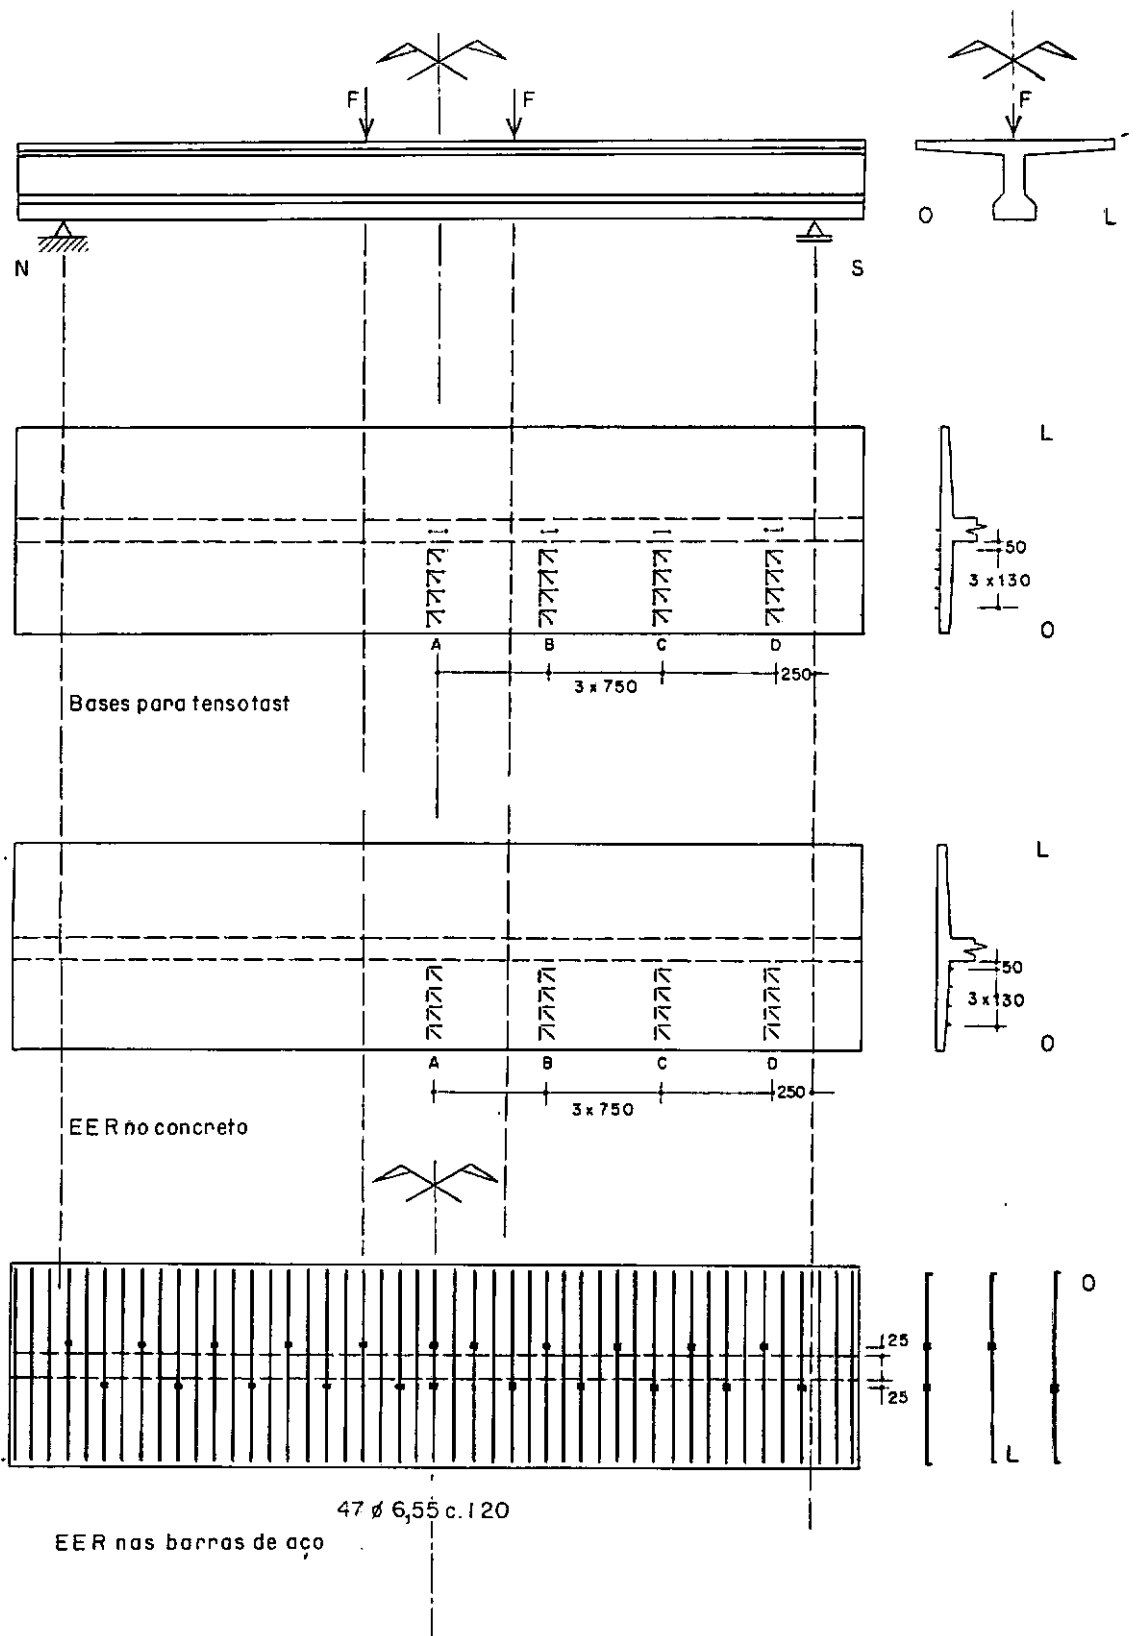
d - Instrumentação da viga T4 - (Cotas em mm)
